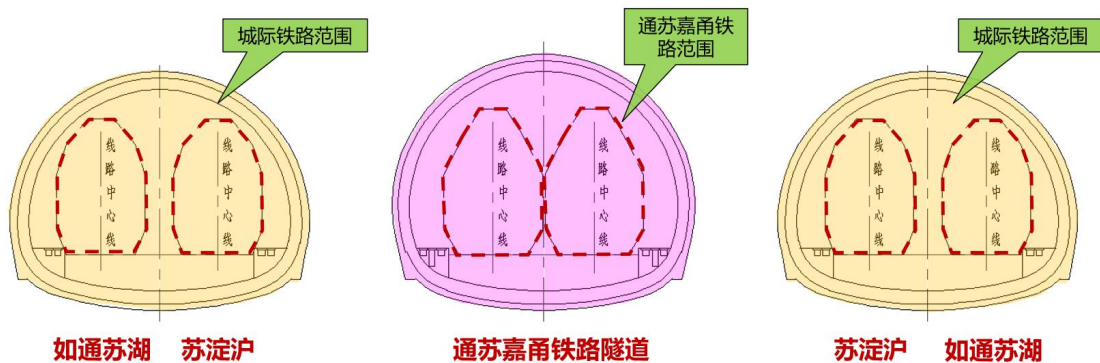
桑田岛城际站暗挖段投资分摊横断面示意图
